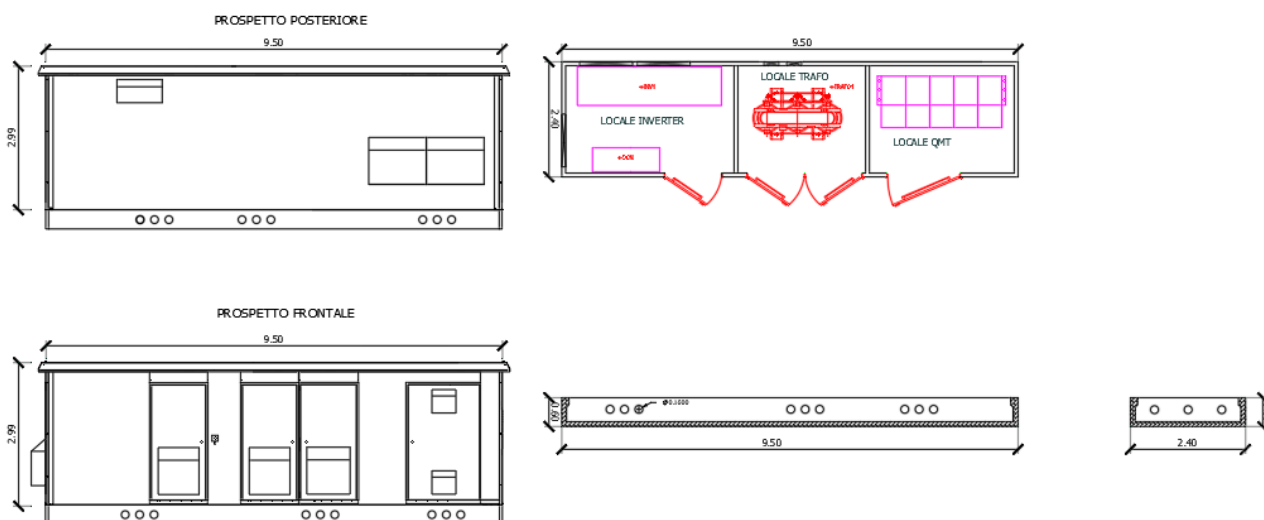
pianta e prospetto cabine di conversione e trasformazione
